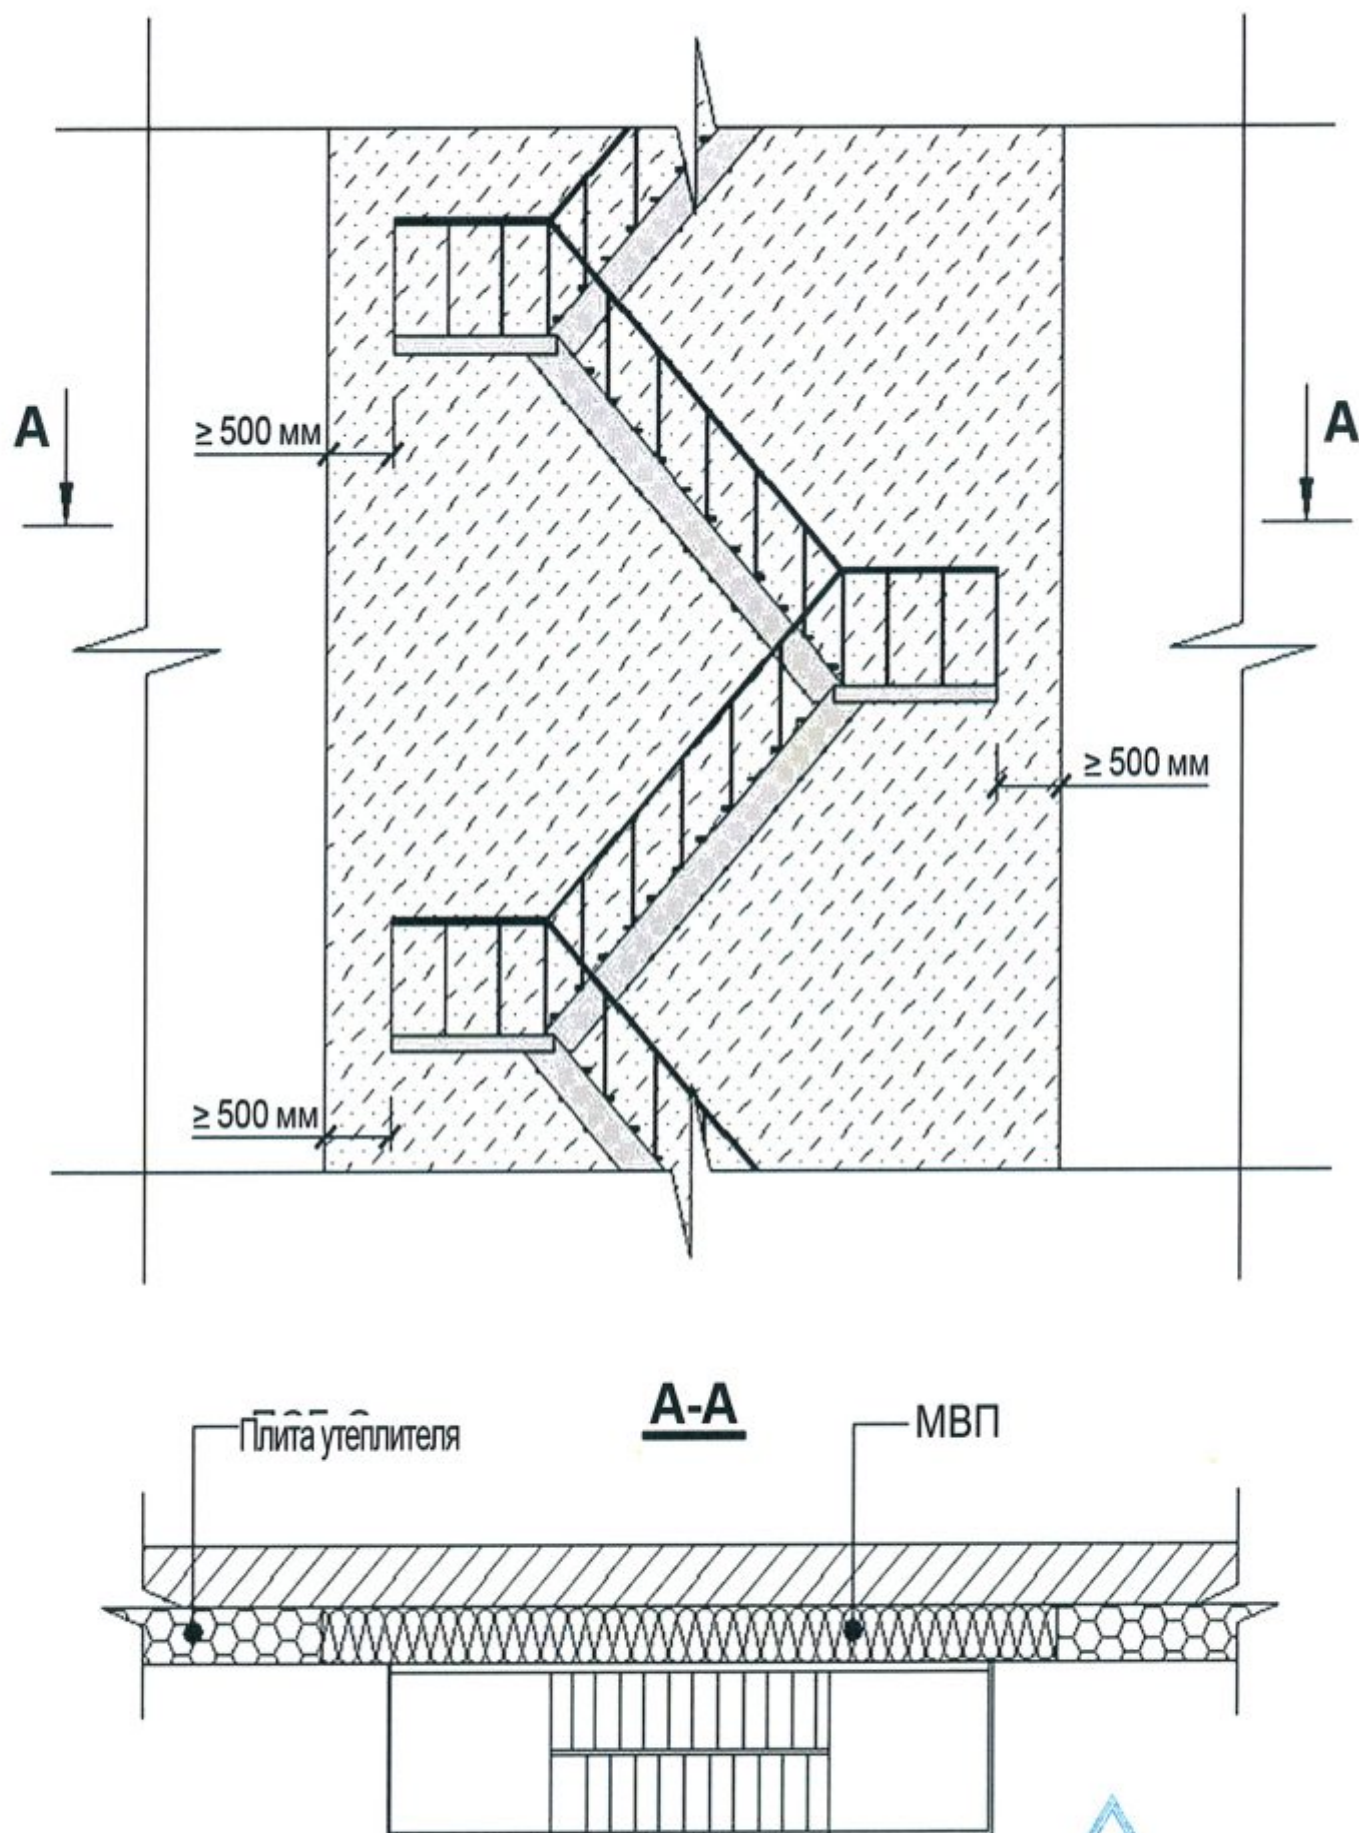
Участки примыкания СФТК к пожарной или наружной маршевой лестнице здания
